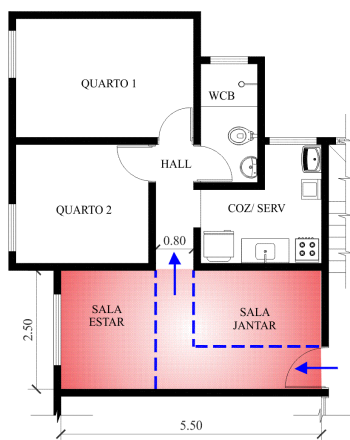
Planta Baixa Pav. Tipo: Setor Social do Residencial Germano Santos (sem escala)
